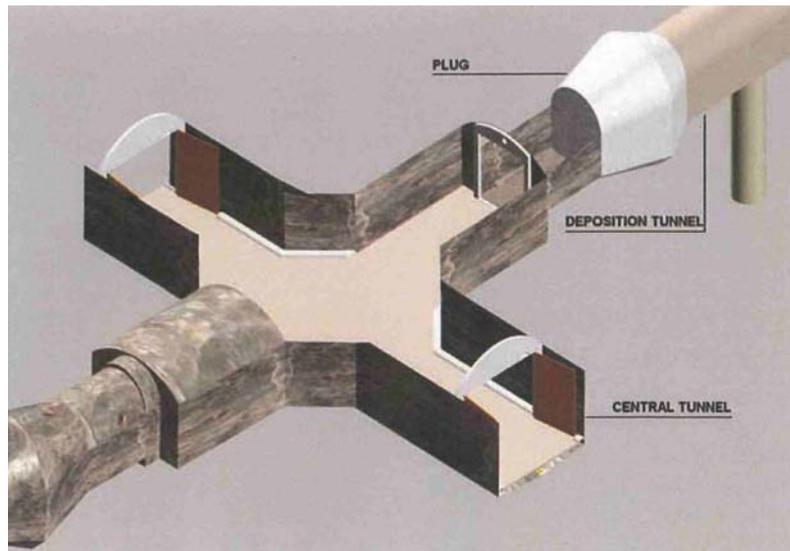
Verschluss der Einlagerungsstrecken /4-4/
